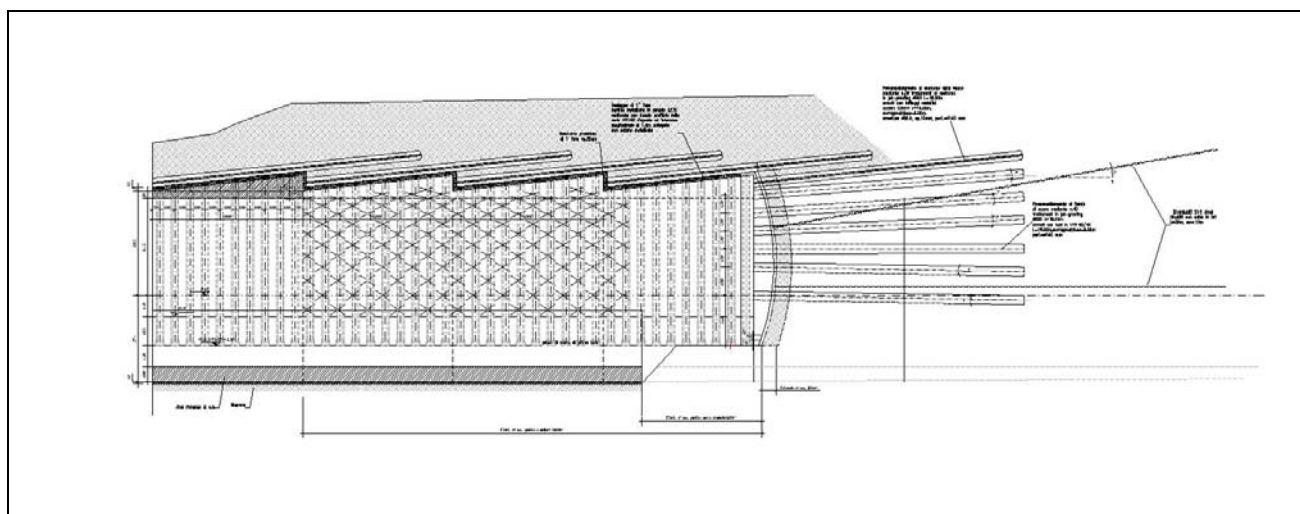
Sezione di scavo tipo GD-C4 Transizione Detrito-Gneiss - Sezione longitudinale
